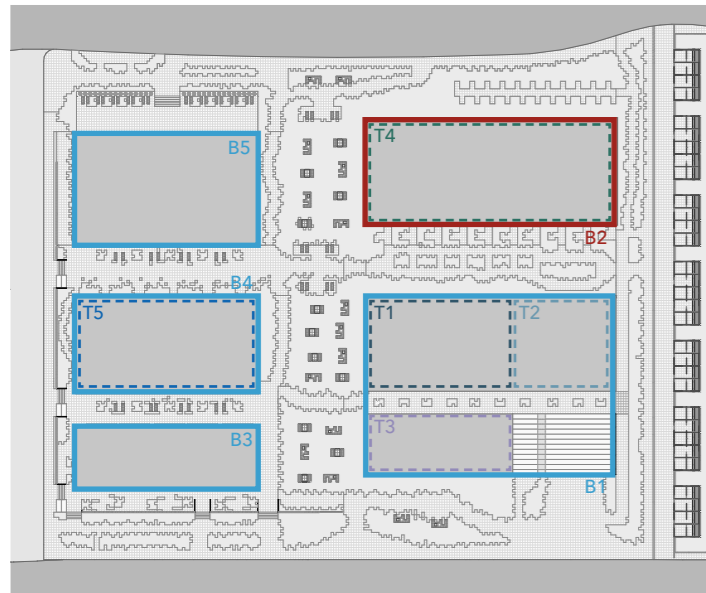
Planta de referencia. Fuente: Autoría propia.
